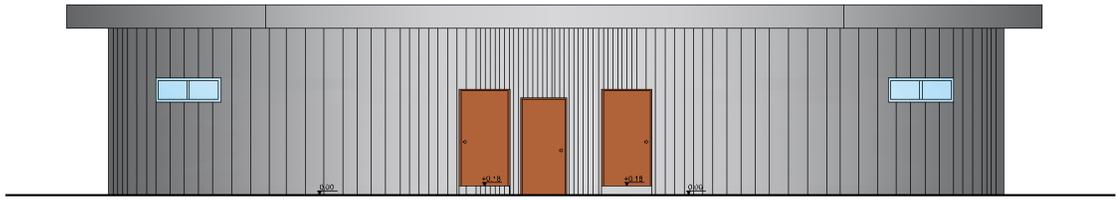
Fachada Frontal - Baterías Sanitarias
